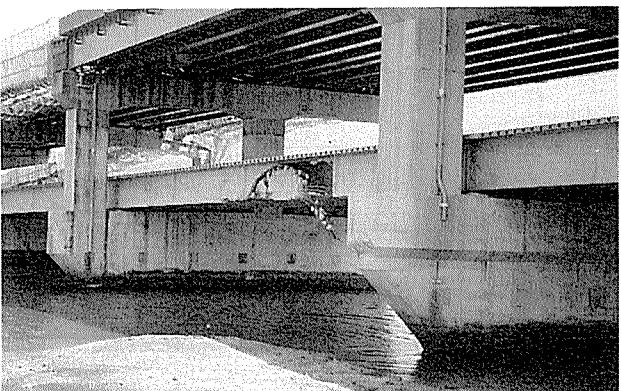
損傷を受けた径間の状況 (P 101～P 102)
